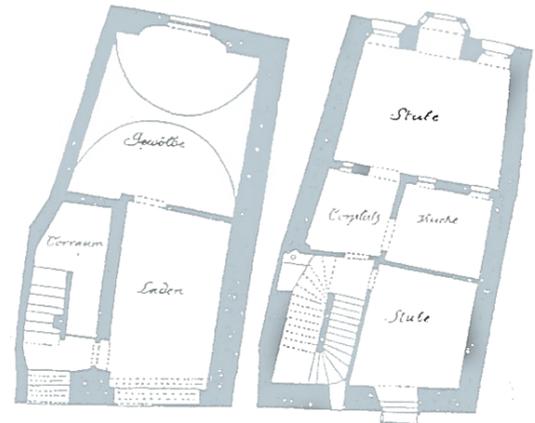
Grundriss eines Handwerkerhauses
